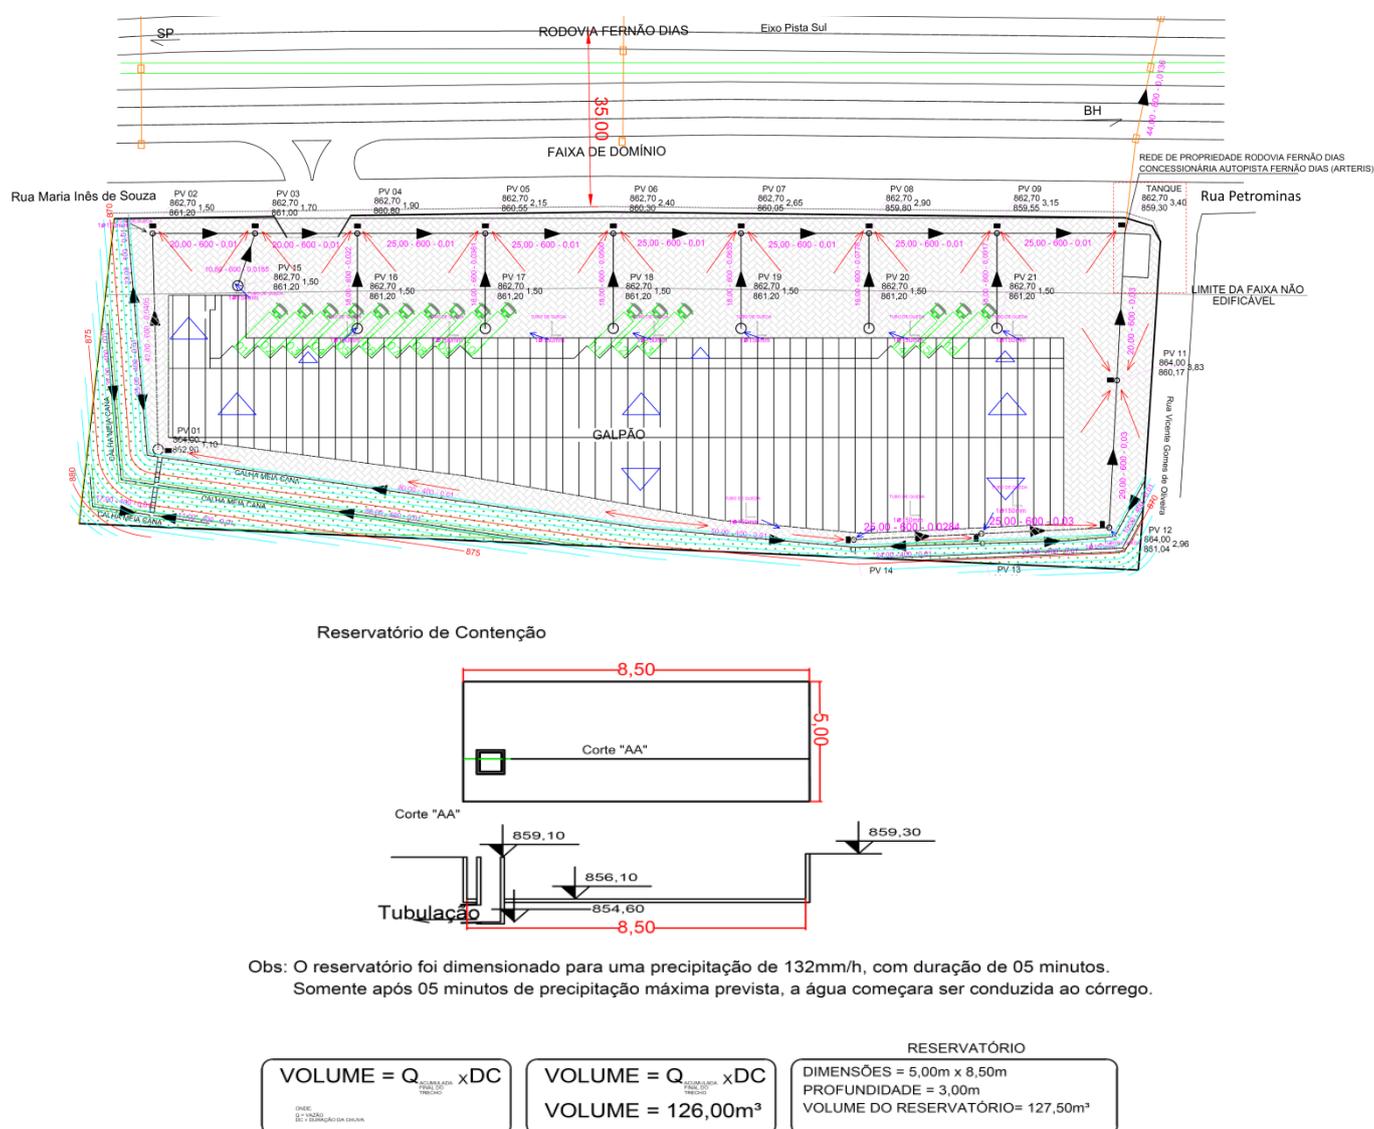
Projeto de drenagem de águas pluviais do empreendimento, aprovado em 18/12/2020.
